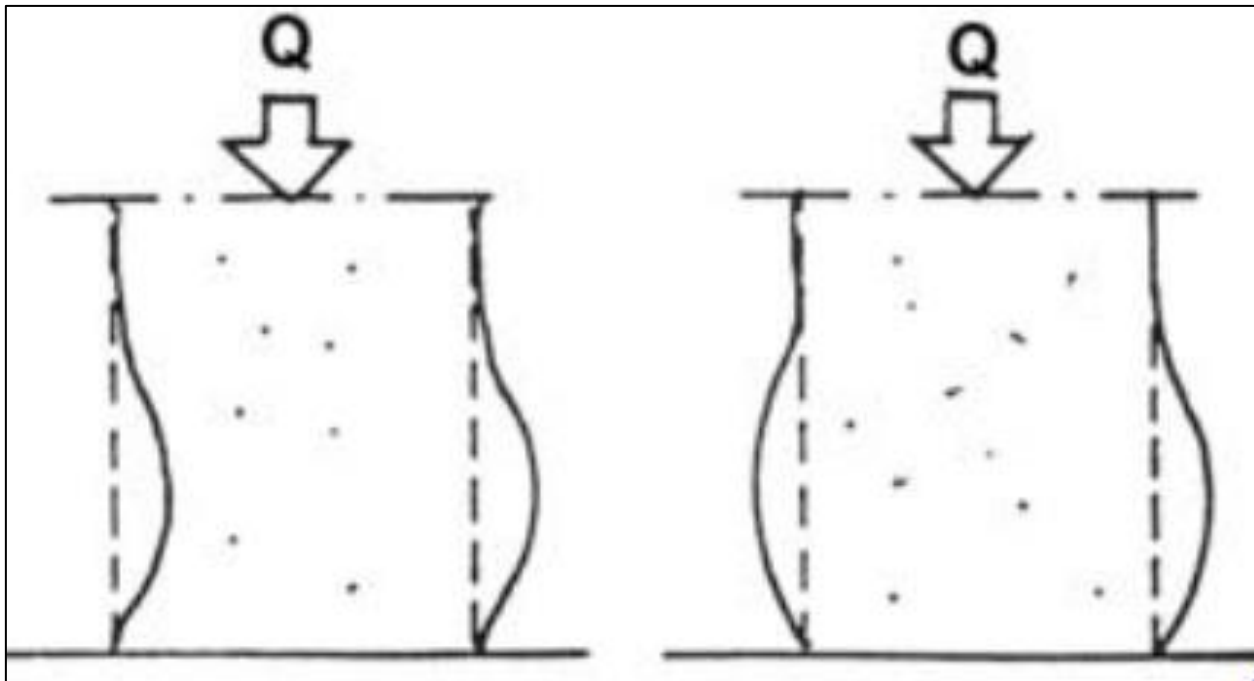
Aplastamiento de los materiales, debido a la sobrecarga en mampostería de adobe- (Centeno Farfán)
